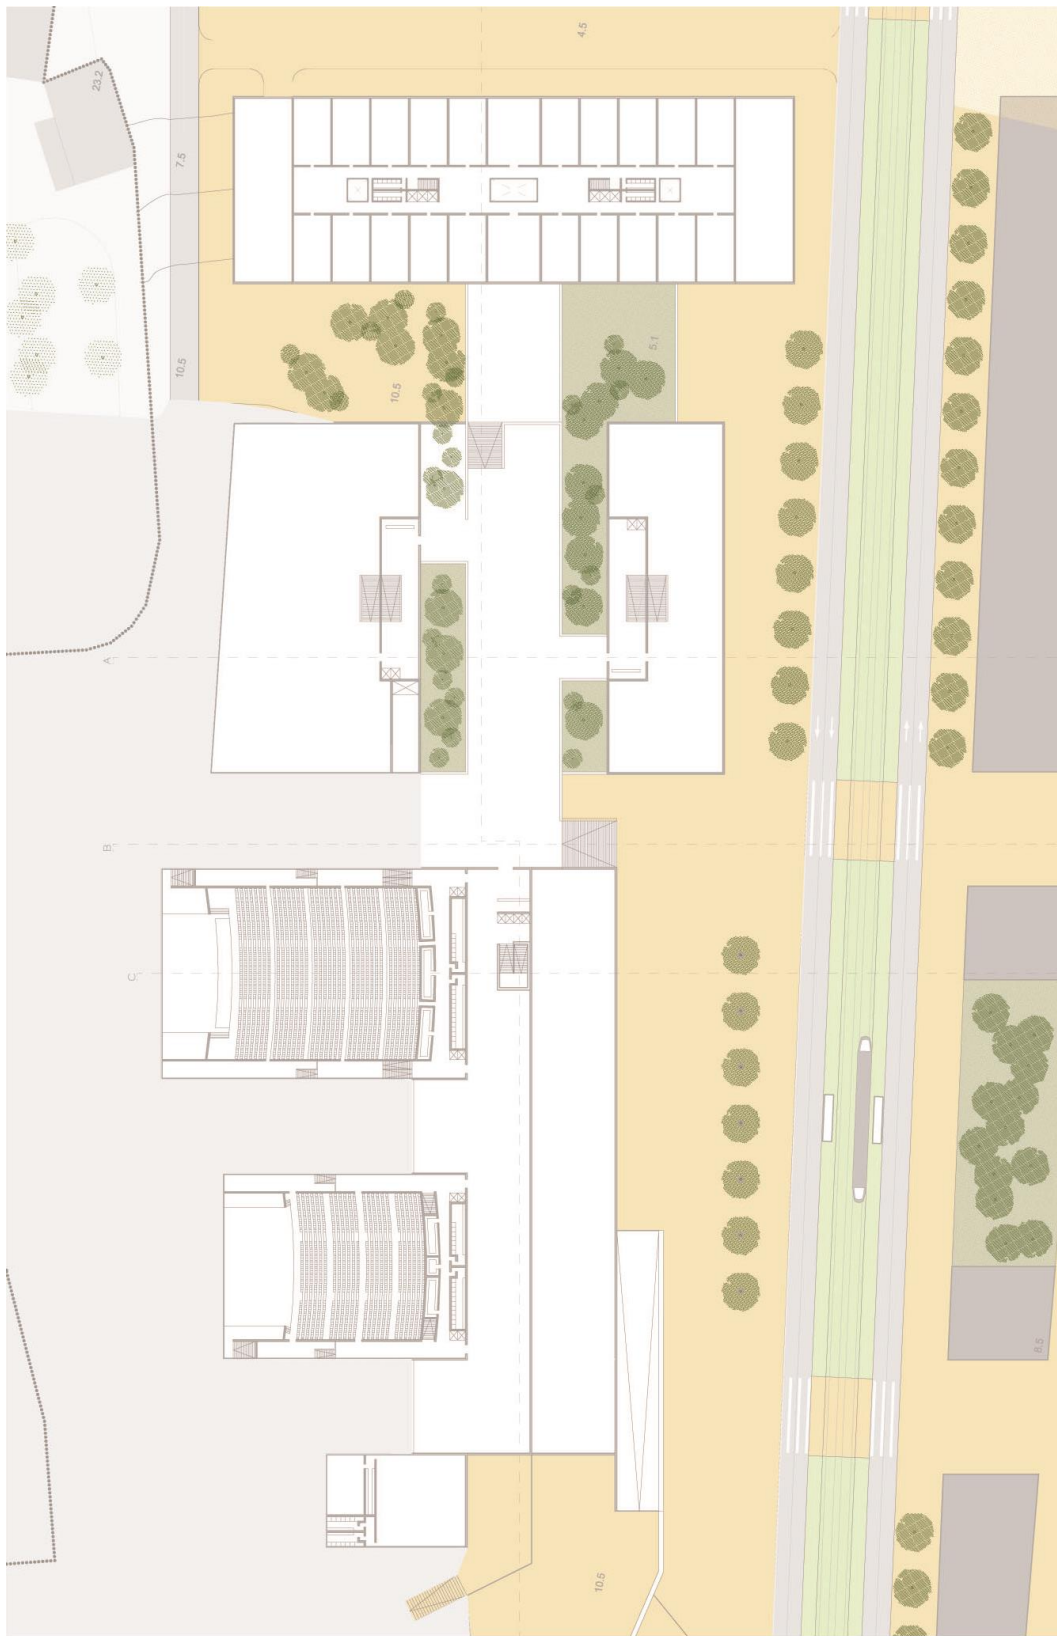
Planta piso 1, cota 10.5. Fonte: Autora
